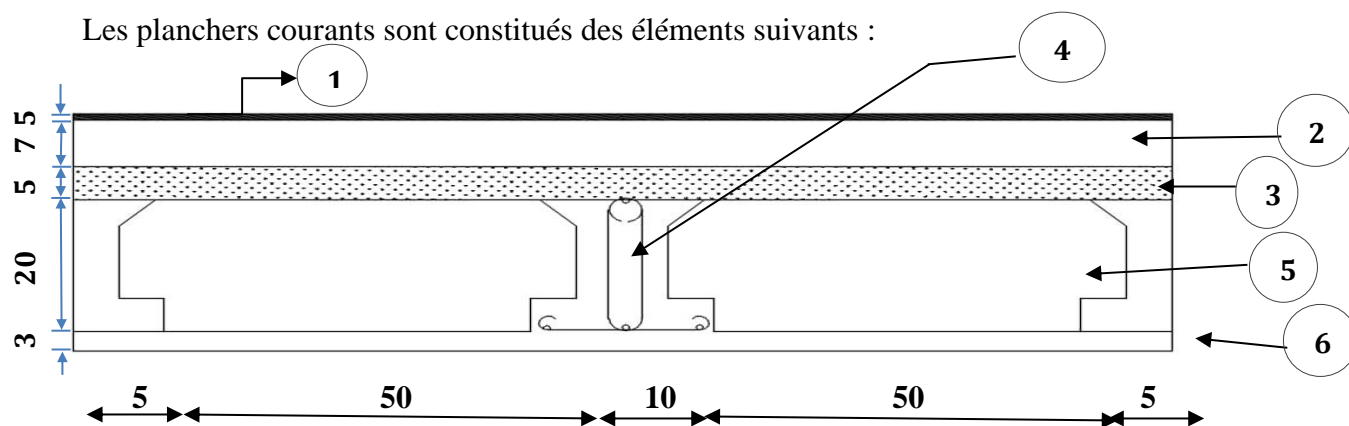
Coupe transversale du plancher haut RDC et 1er étage
